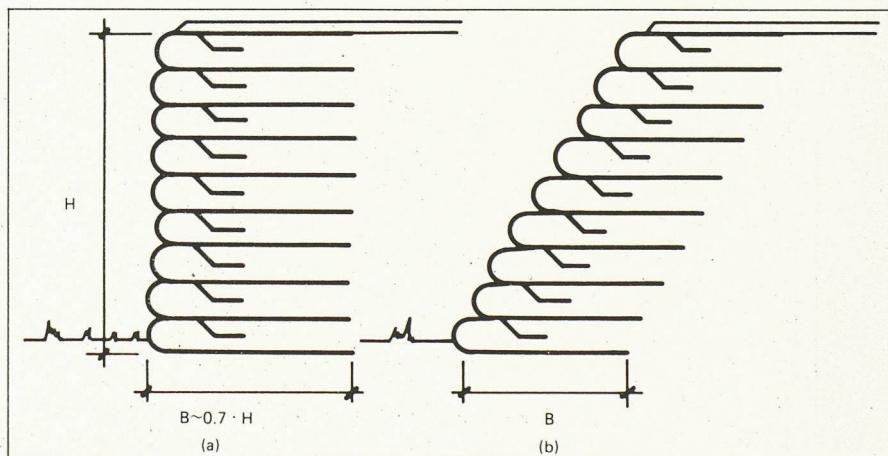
Massifs en terre renforcée par des géotextiles : parement vertical (a) et parement incliné (b).
